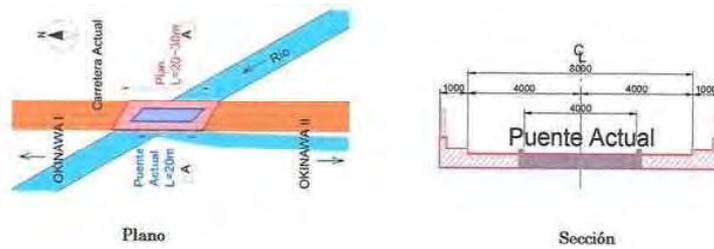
Plano de ubicación del puente a ser reconstruido
